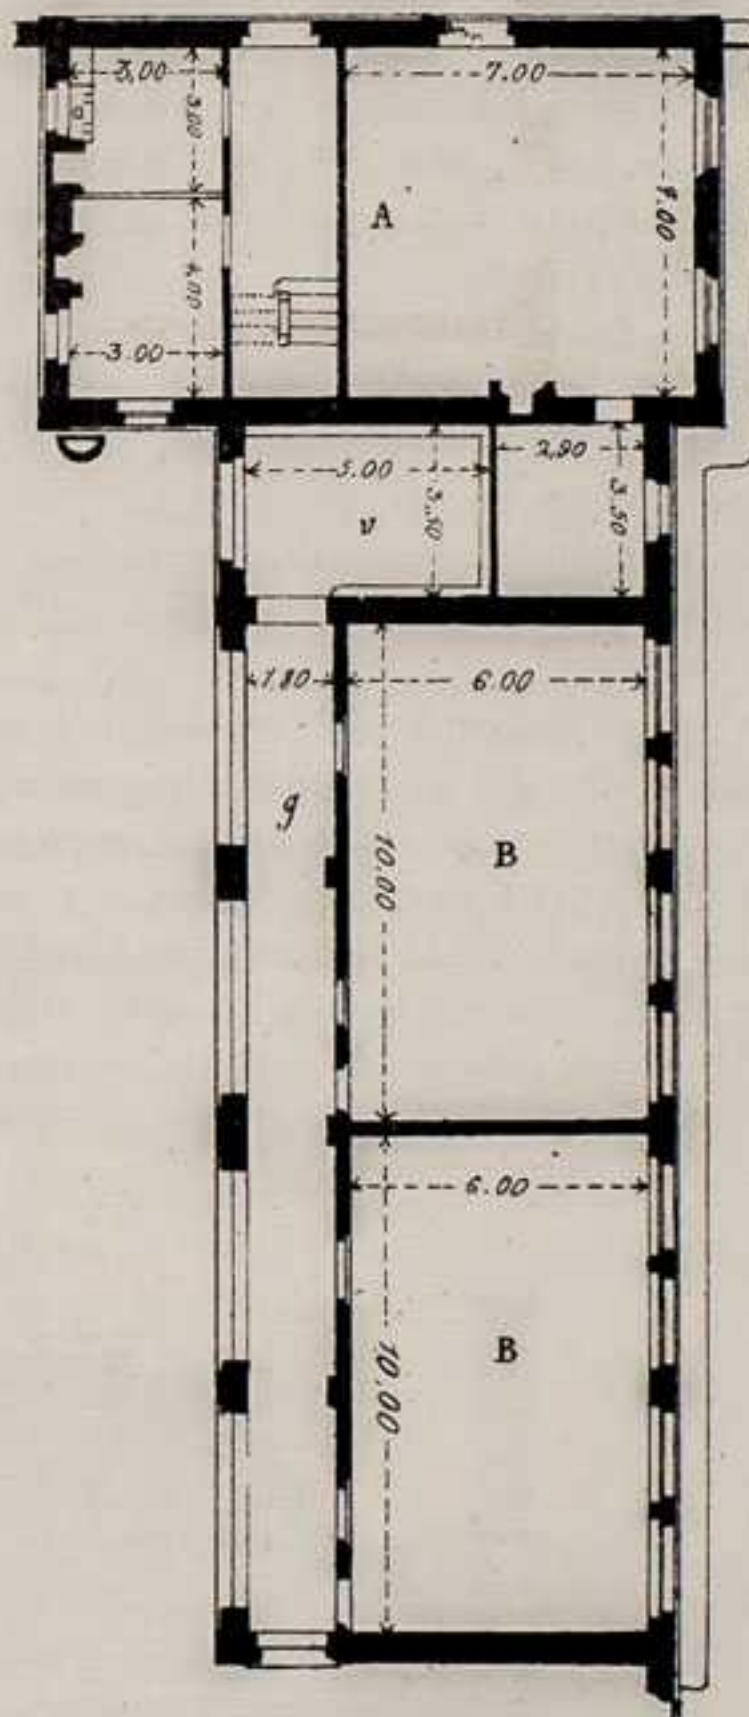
Pianta del fabbricato scolastico a piano terreno.
